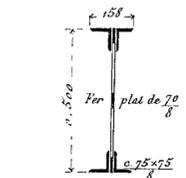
Section de la poutrelle de rive supportant le garde-corps.
